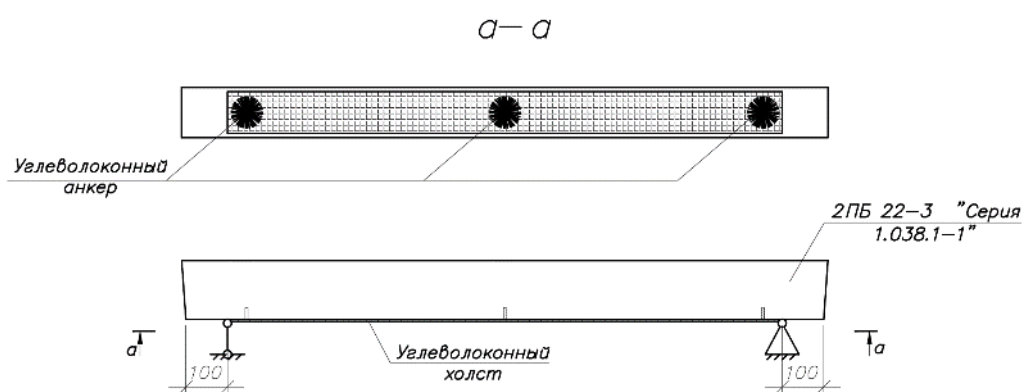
Железобетонный балочный элемент, усиленный внешним композитным армированием
